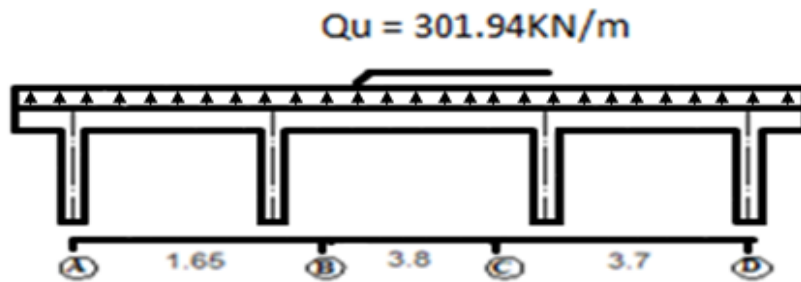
Sollicitation revenant à la poutre de rigidité
